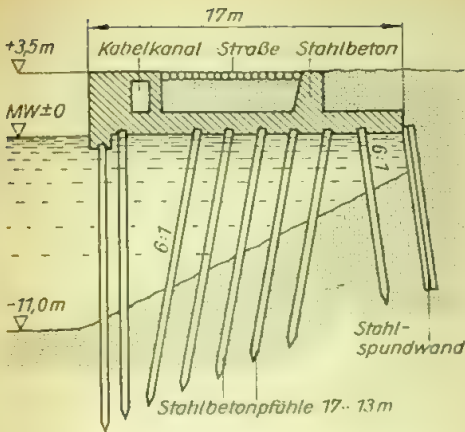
Stahlbetonplatte auf Pfahlrost
